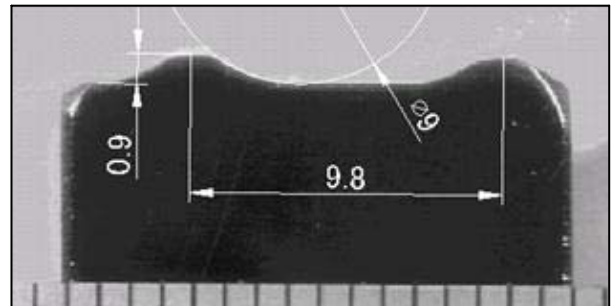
鉄筋の縦断面における節の形状 (単位: mm)
